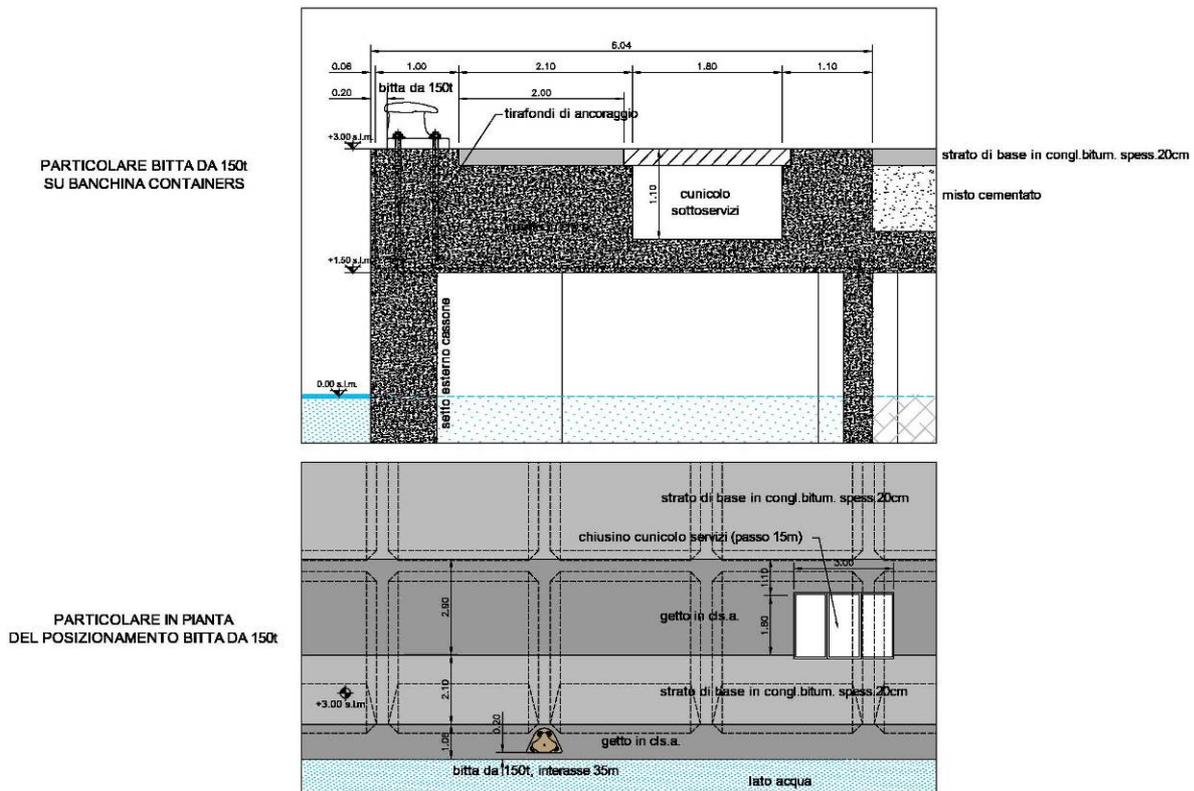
Banchina container - sezione tipo delle pavimentazioni.
